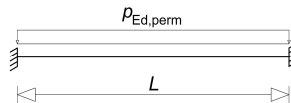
Statisches System der einachsrig gespannten Stahlbetondecke
